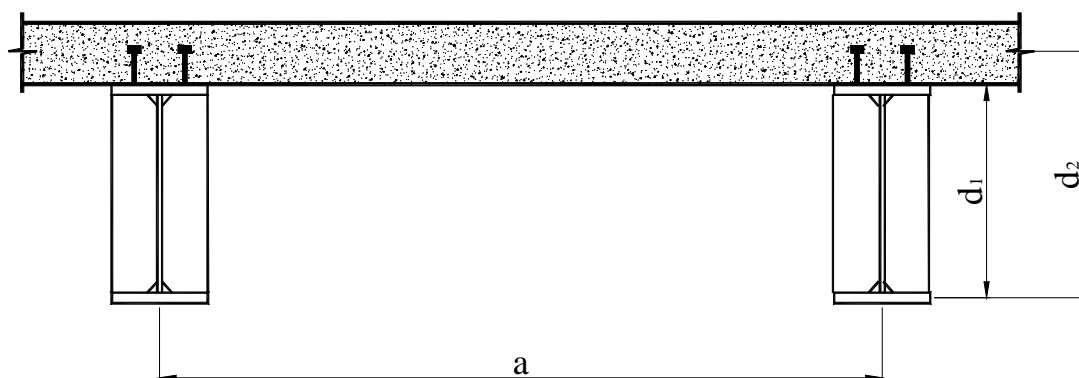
Vigas mistas com restrição discreta dada pela laje.
